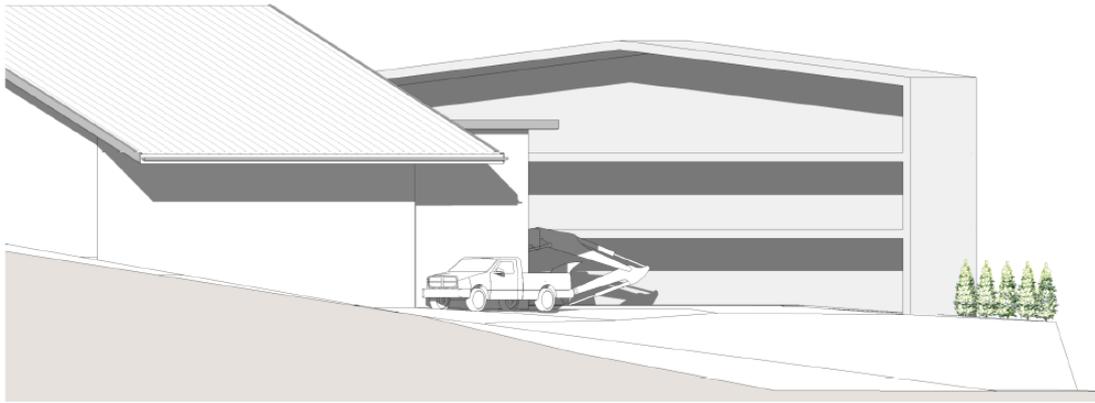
Ansicht Ost seitens des Planungsbüros m³ PLAN + BAU GmbH (ohne Maßstab)
